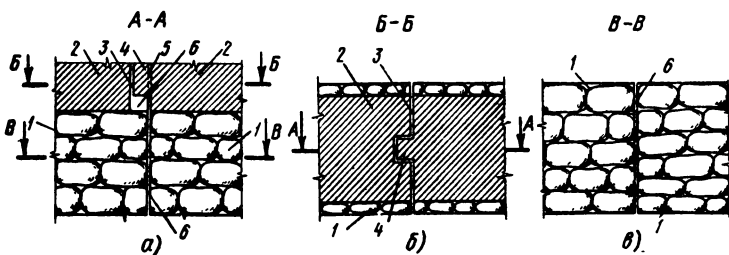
Переход от осадочного шва фундамента к осадочному шву стены: *а* — разрез, *б* — план стены, *в* — план фундамента; 1 — фундамента, 2 — стена, 3 — шов стены, 4 — шпунт, 5 — зазор для осадки, 6 — шов фундамента
